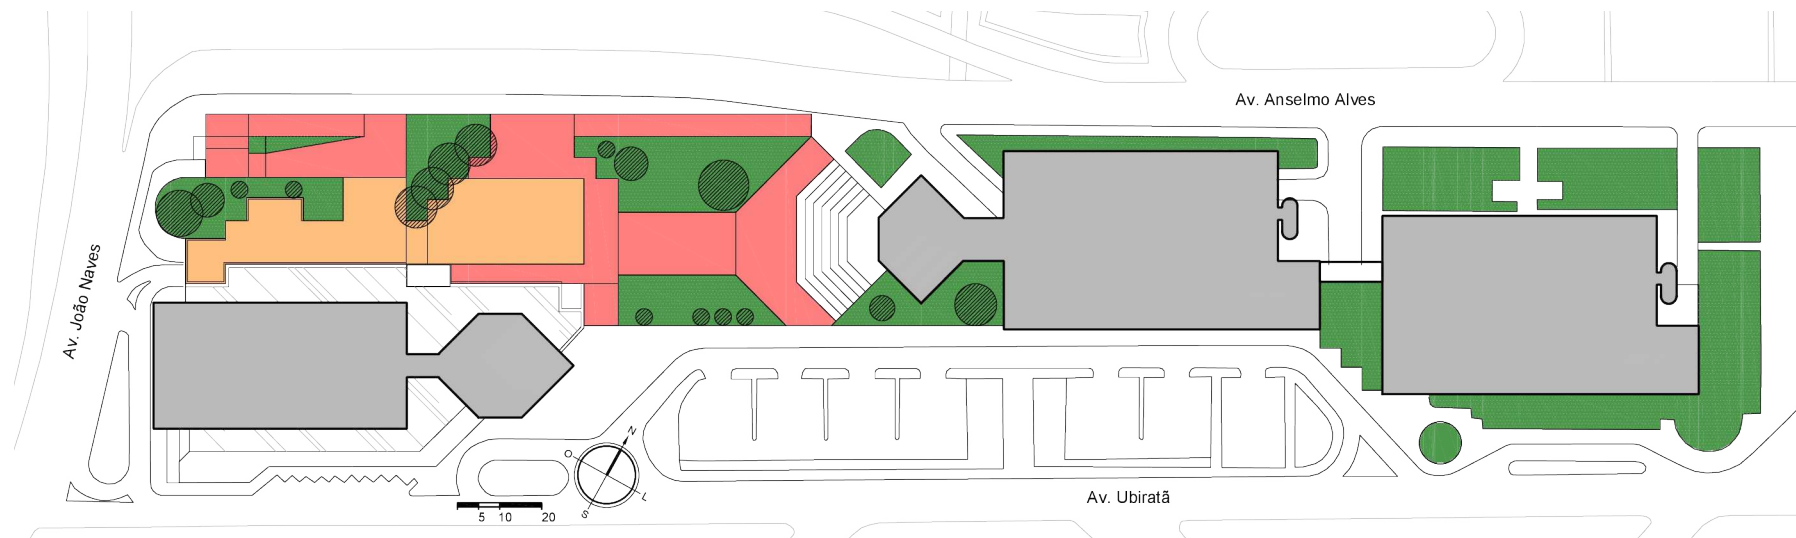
Planta áreas verdes e paginação de piso da praça. Fonte: Autor (2019).
